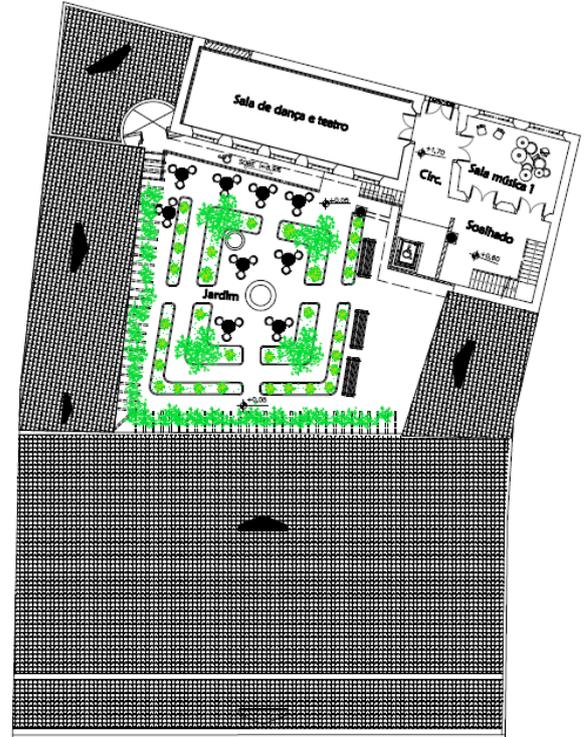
Proposta de uso - Planta-baixa térreo bloco 2
